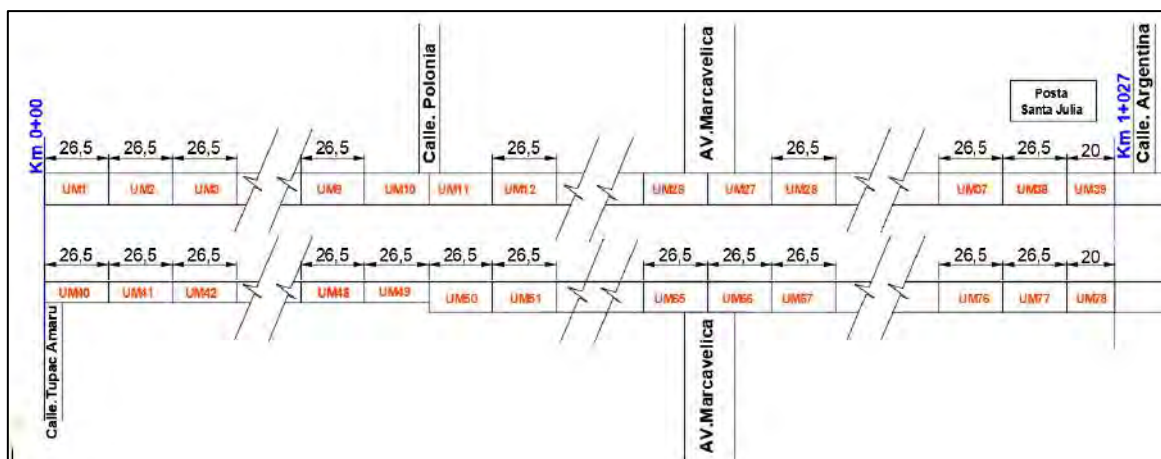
Plano de distribución de las unidades de muestras en ambas calzadas
